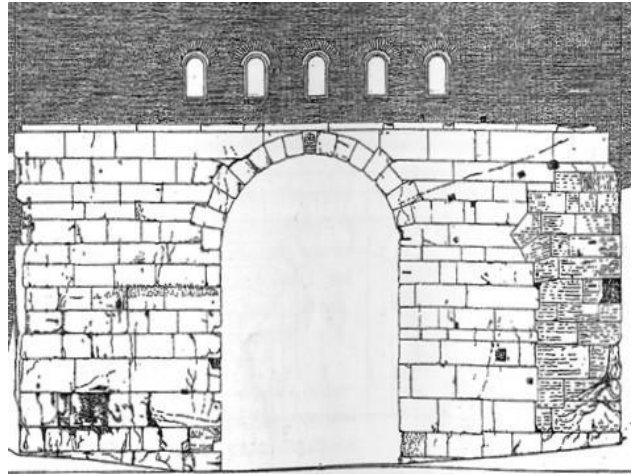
Porta Appia, particolare del rilievo del prospetto nord. Da BIZZOTTO 2001.
